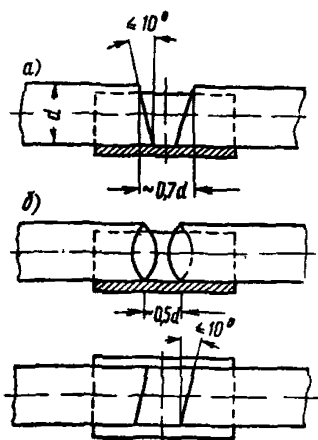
Допускаемые условия сборки стыковых соединений горизонтальных стержней со скобами-подкладками при расположении торцов стержней под углом к их продольной оси, отличающимся от 90°
